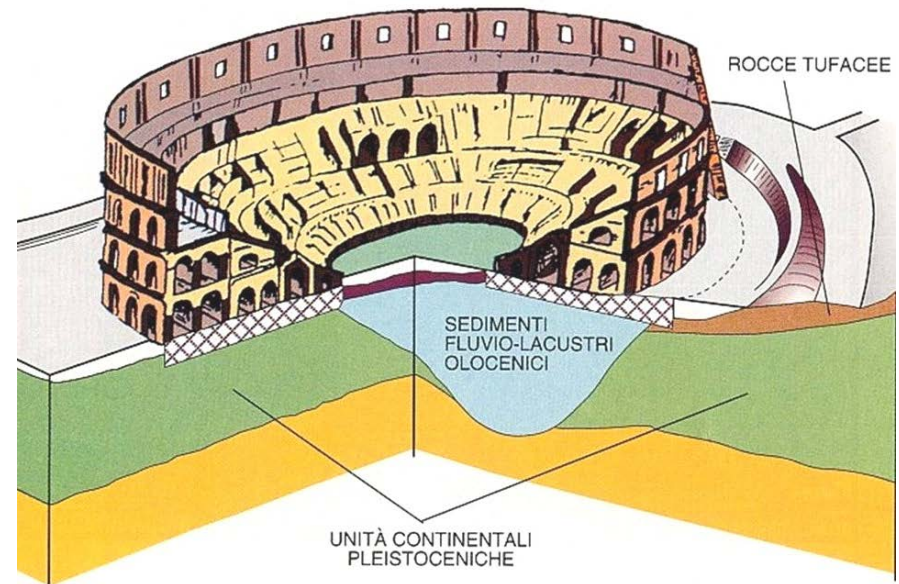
Sezione schematica dell’anfiteatro Flavio, 72-80, archivio [www.strutturista.com](http://www.strutturista.com)
